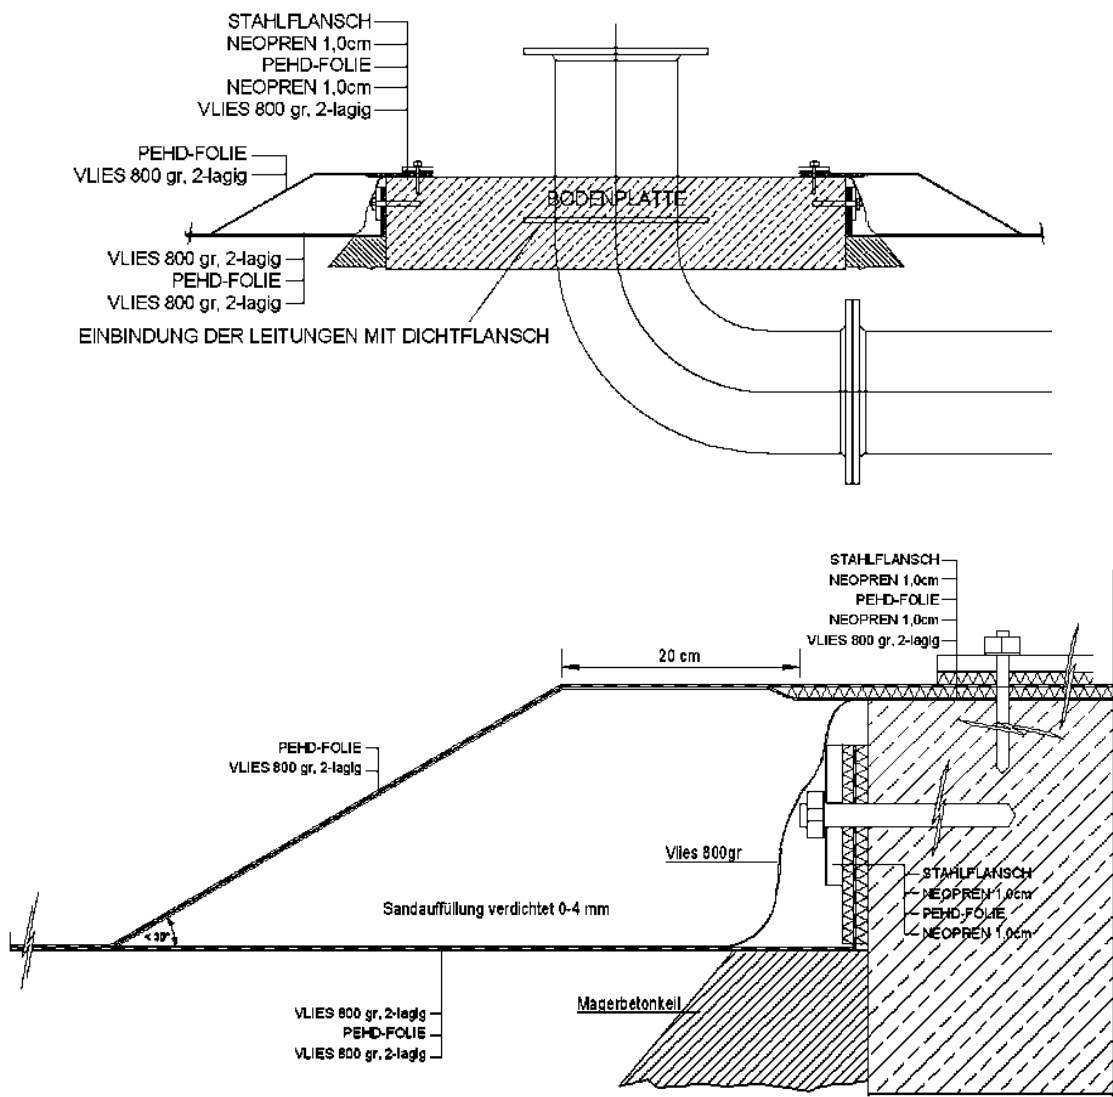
Durchführungsbauwerk mit doppelter Klemmkonstruktion (oben), Detail Anschluss PEHD-Folie (unten) [59: S. 110]
